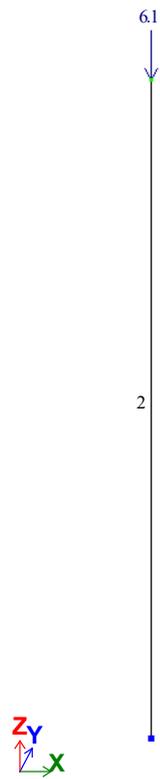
Загружение №3. Постоянная нагрузка от пирога кровли
